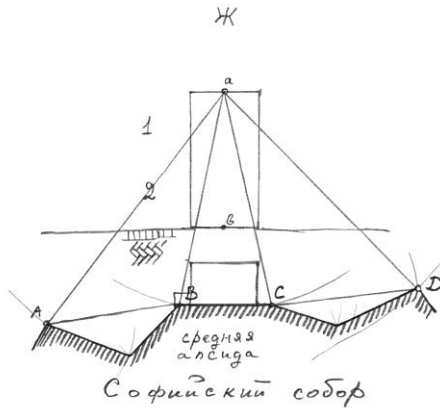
Креслення № 13. КС-50<sup>б</sup>. Генеральный план. Схема прив'язки (НАДР, 922, арк. 101)
